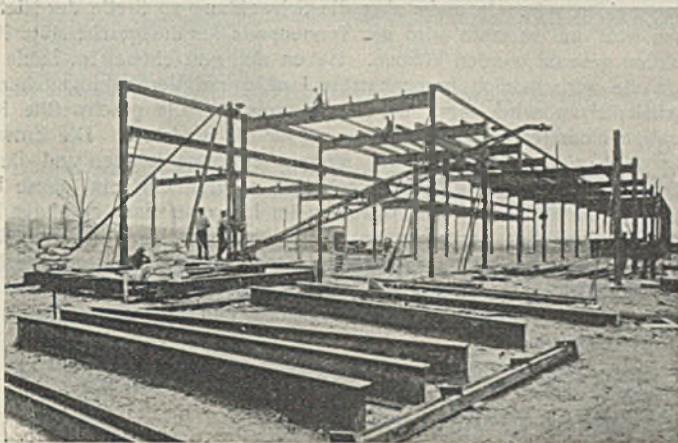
Stahlhalle in Youngtown, Gesamtbreite 67 m, während der Montage; auch der im Vordergrund befindliche Kran ist ganz geschweißt.
